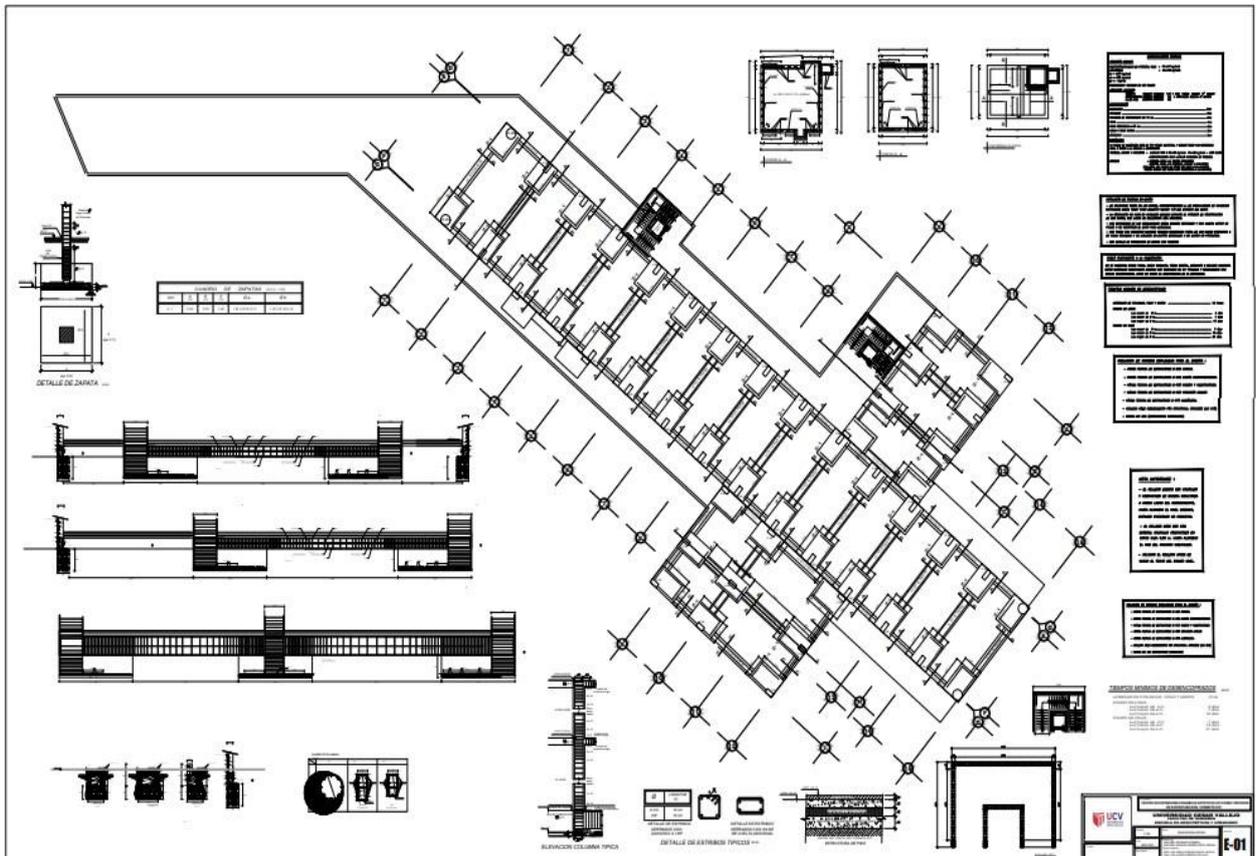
Plano de cimentación sótano. Fuente: Elaboración Propia
